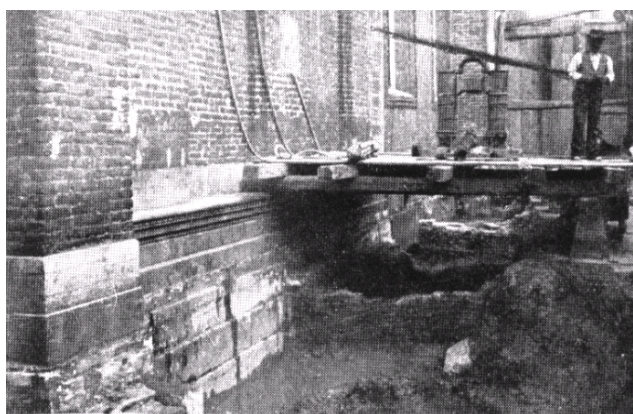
Immagine dell'intervento di consolidamento delle fondazioni del campanile del 1904.
